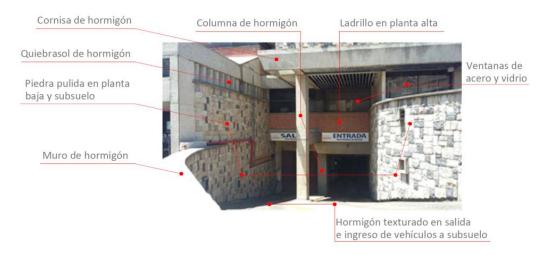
Vista sobre las calles Primera Constituyente y Juan Montalvo, esquina. Fuente: Eduardo Rivadeneira
